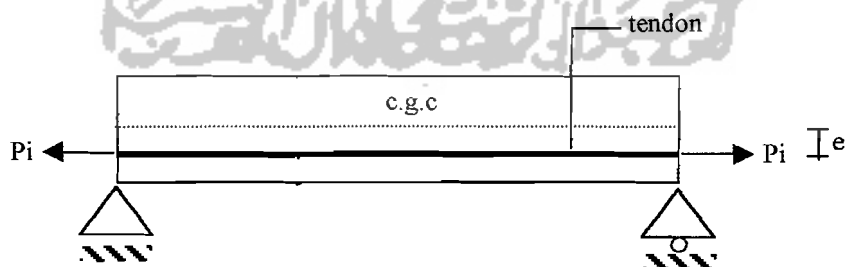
Struktur beton prategang dengan tendon sentris
